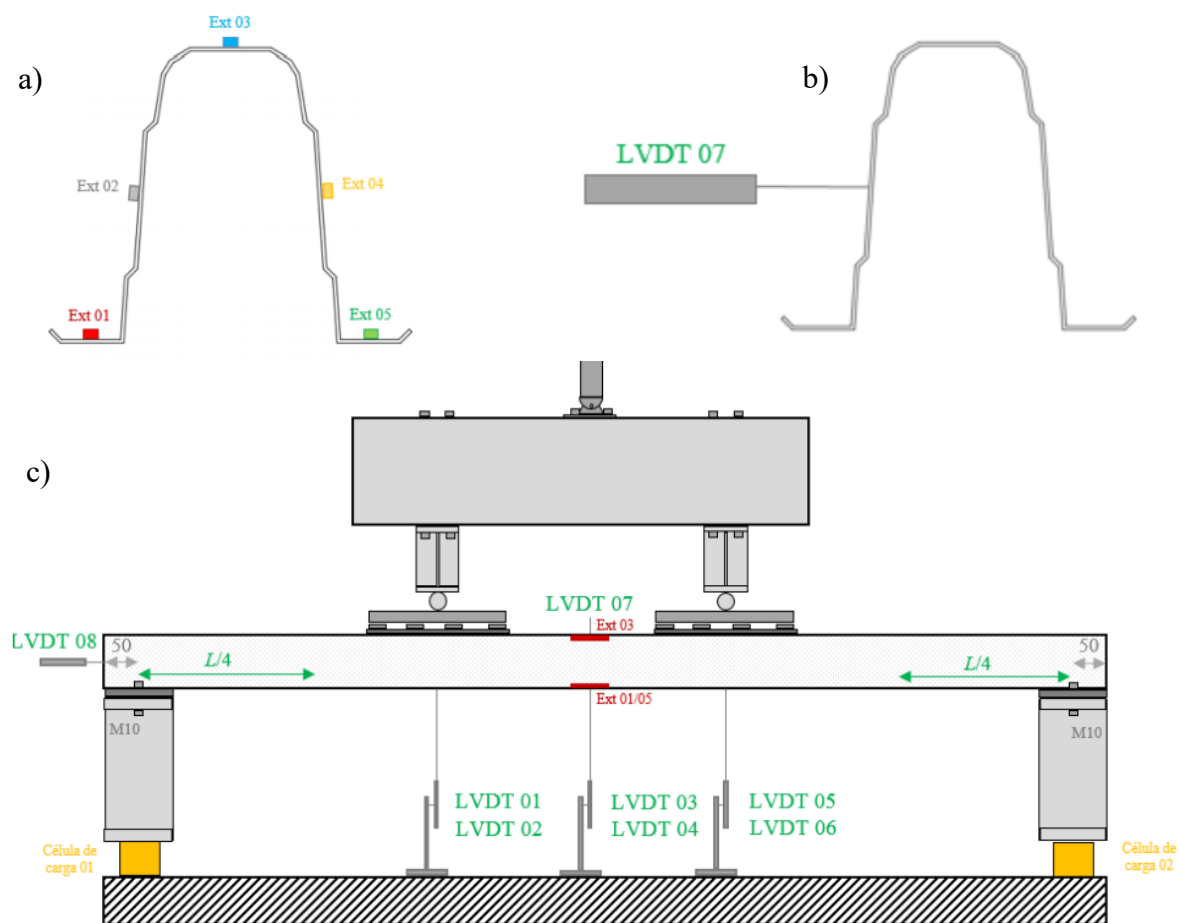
a) Localização dos extensómetros utilizados; b) LVDT transversais ao perfil; c) Localização dos LVDT verticais e horizontais
